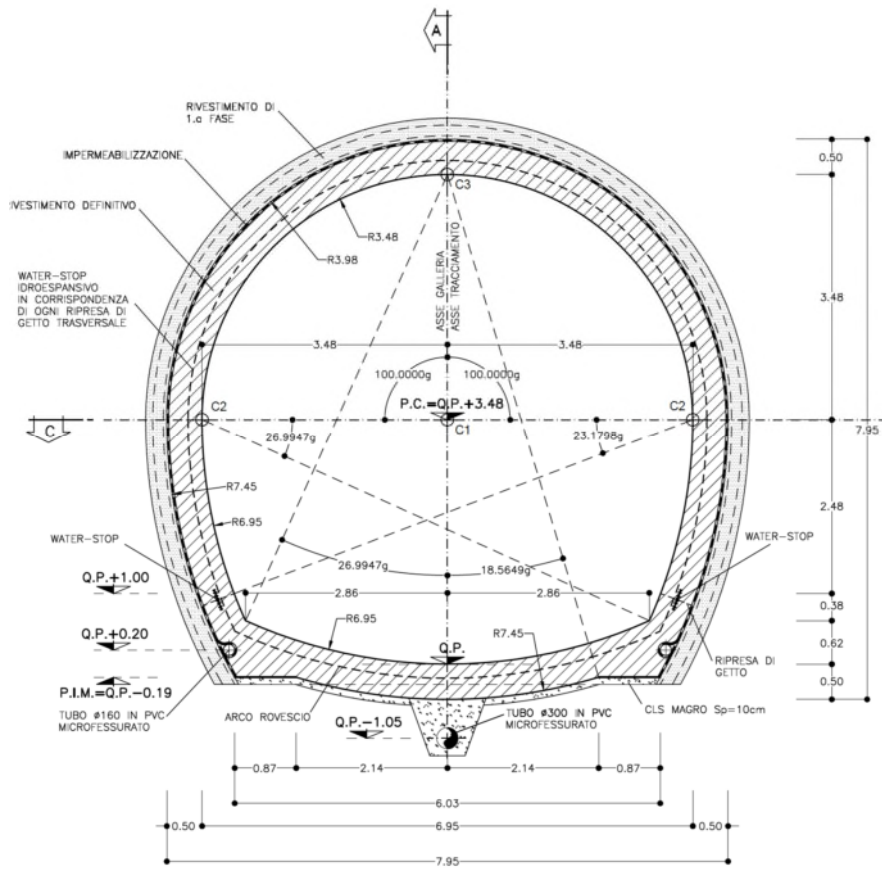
Sezione Tipo Ac – Carpenteria – Sezioni
